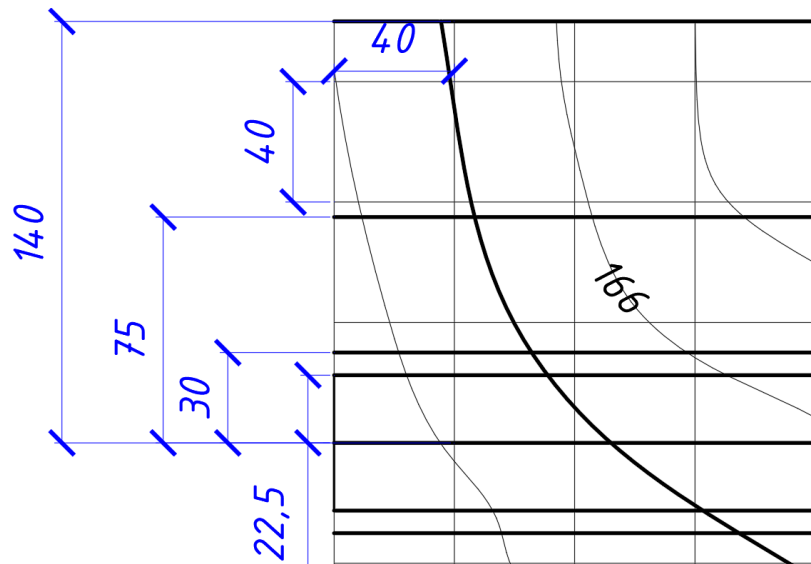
Зображення відкладених ліній необхідних елементів плану вертикального планування
